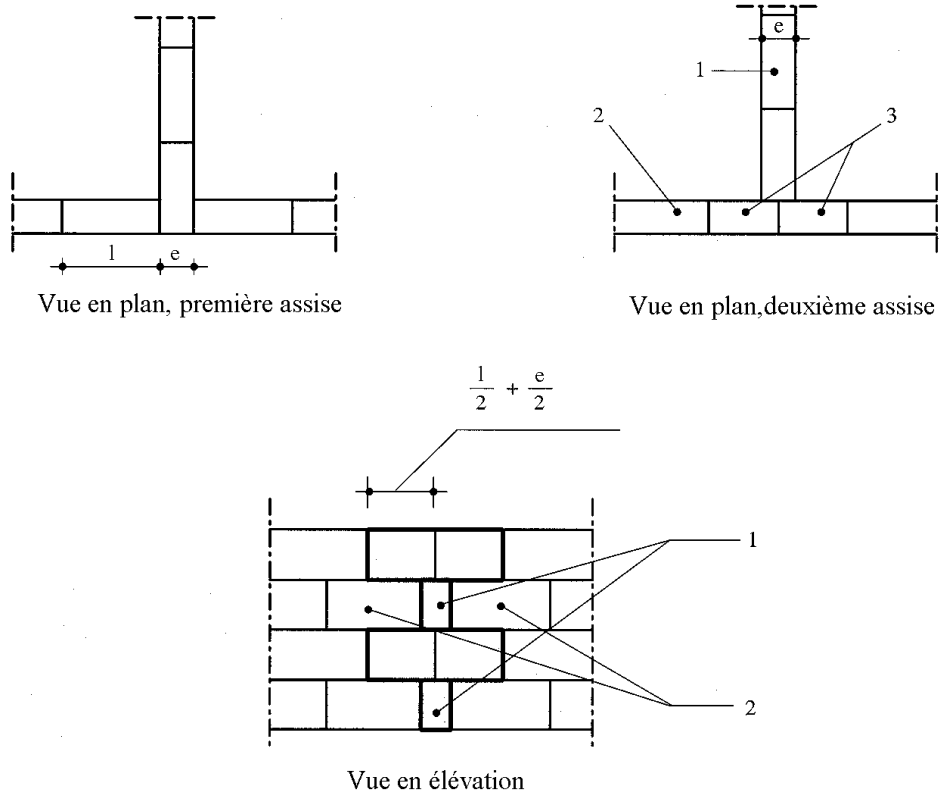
Jonction de 2 murs en matériaux facilement sciables (NBN ENV 1996-1-1 NAD, 2002)
